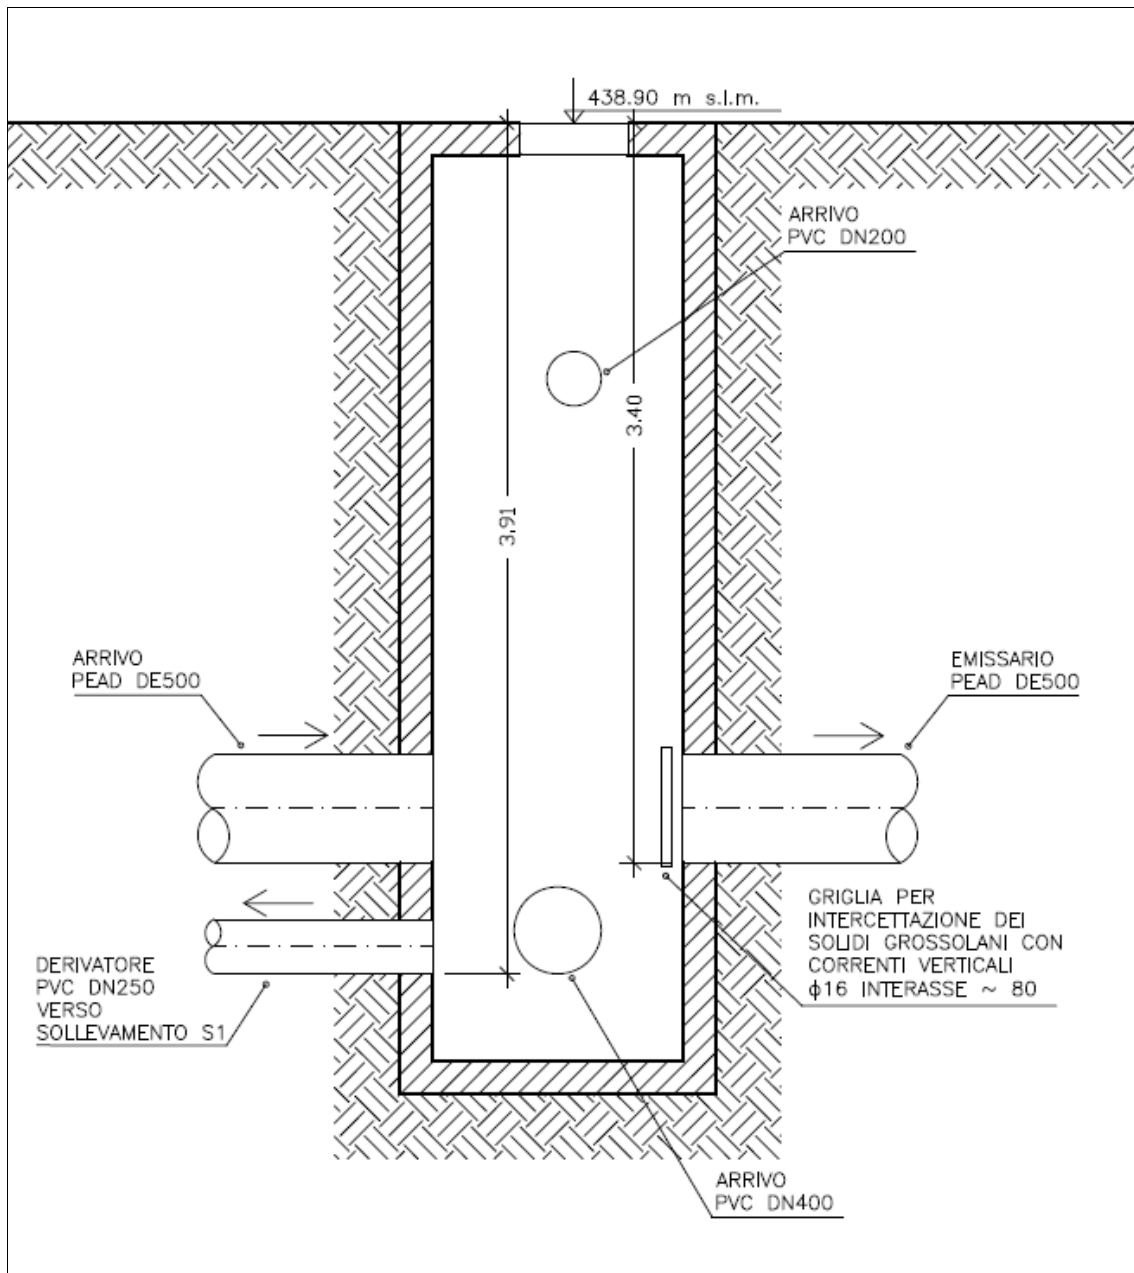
Sezione scolmatore di progetto – Pozzetto G
